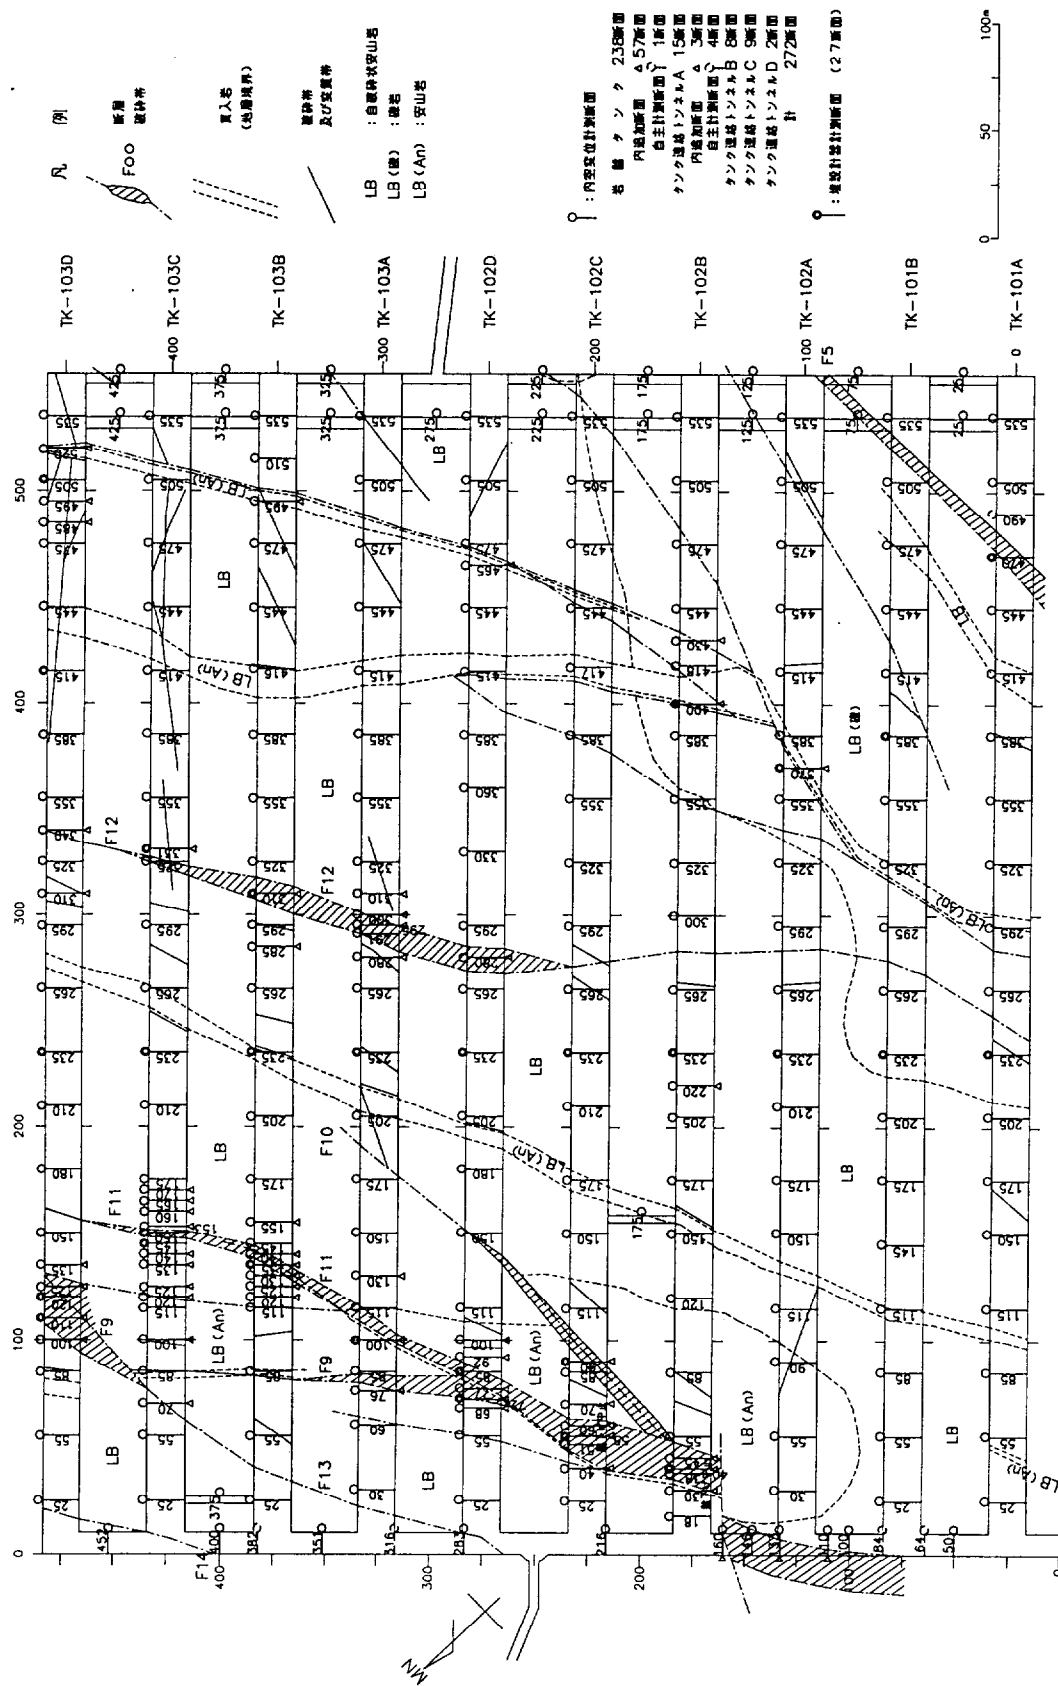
内空変位計測断面平面配置図 (掘削完了時点) 9) を加筆修正
